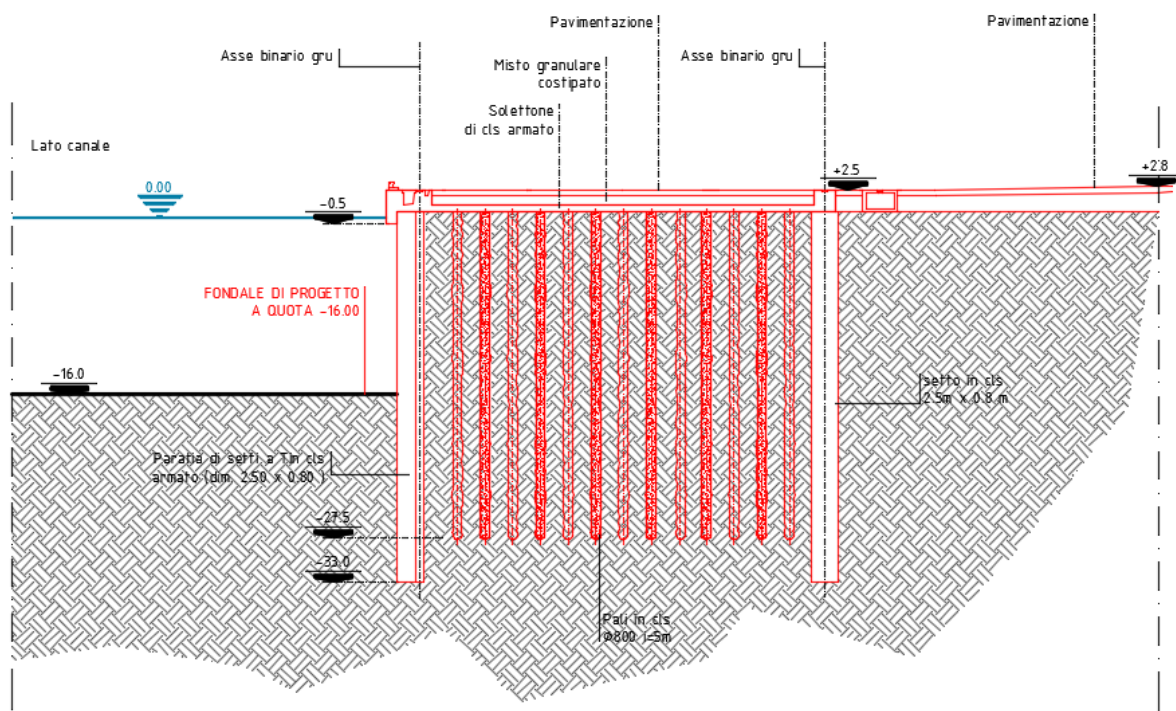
Fasi costruttive: completamento della banchina e dei piazzali di stoccaggio, con realizzazione delle pavimentazione previa esecuzione dei sottoservizi
